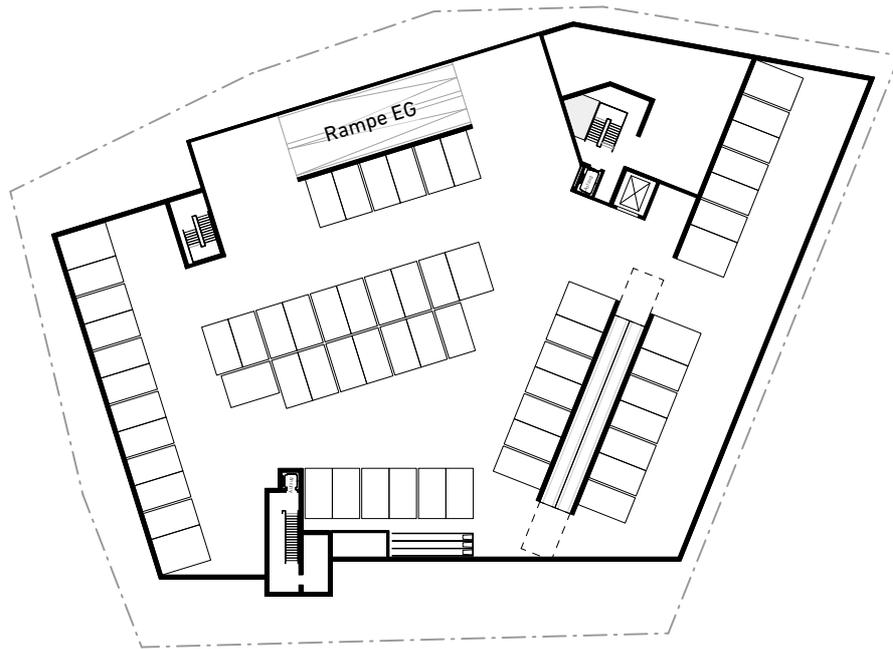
Das Vorhaben - Grundriss Unter-/Tiefgaragengeschoss (Vorentwurf)
